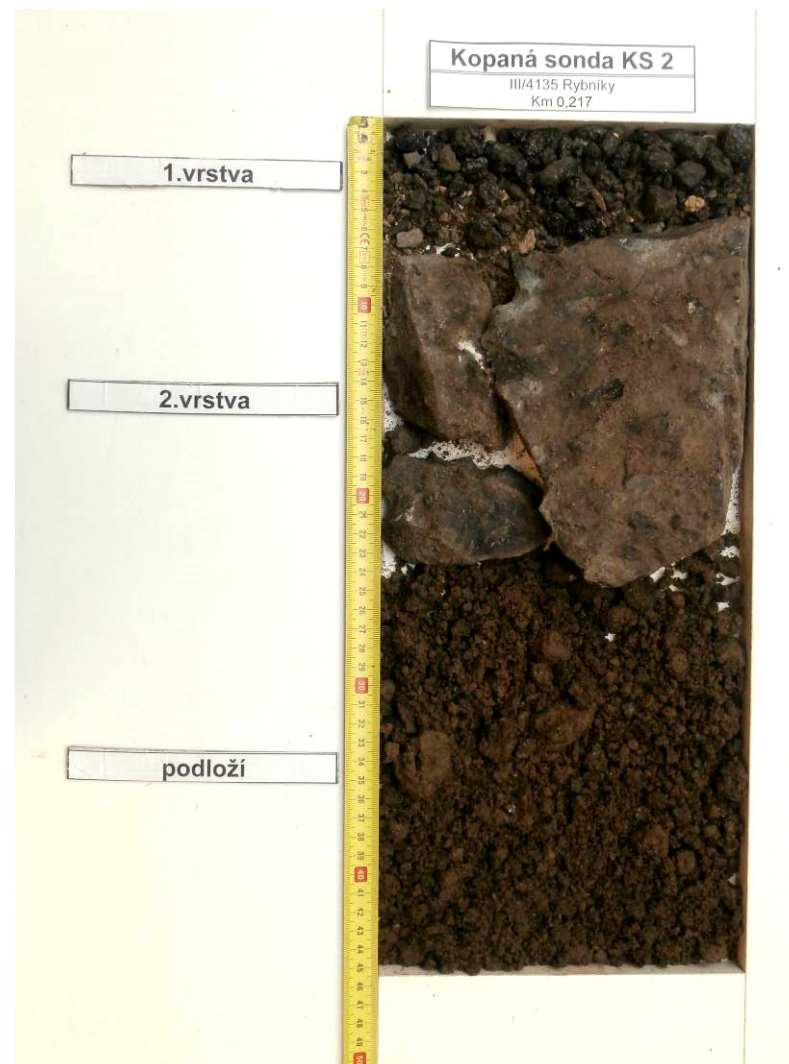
a č. 4 - Kopaná sonda KS 2
